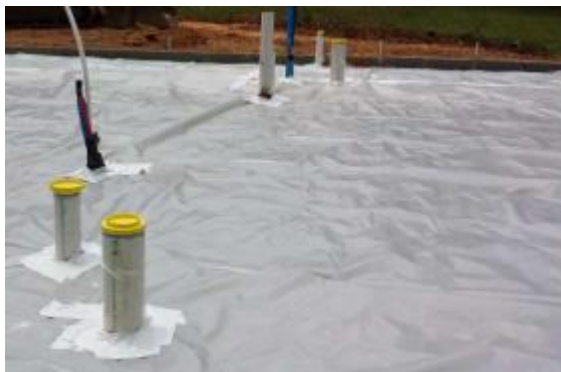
Tubulações de esgoto colocadas previamente a concretagem da laje de fundação [27]
